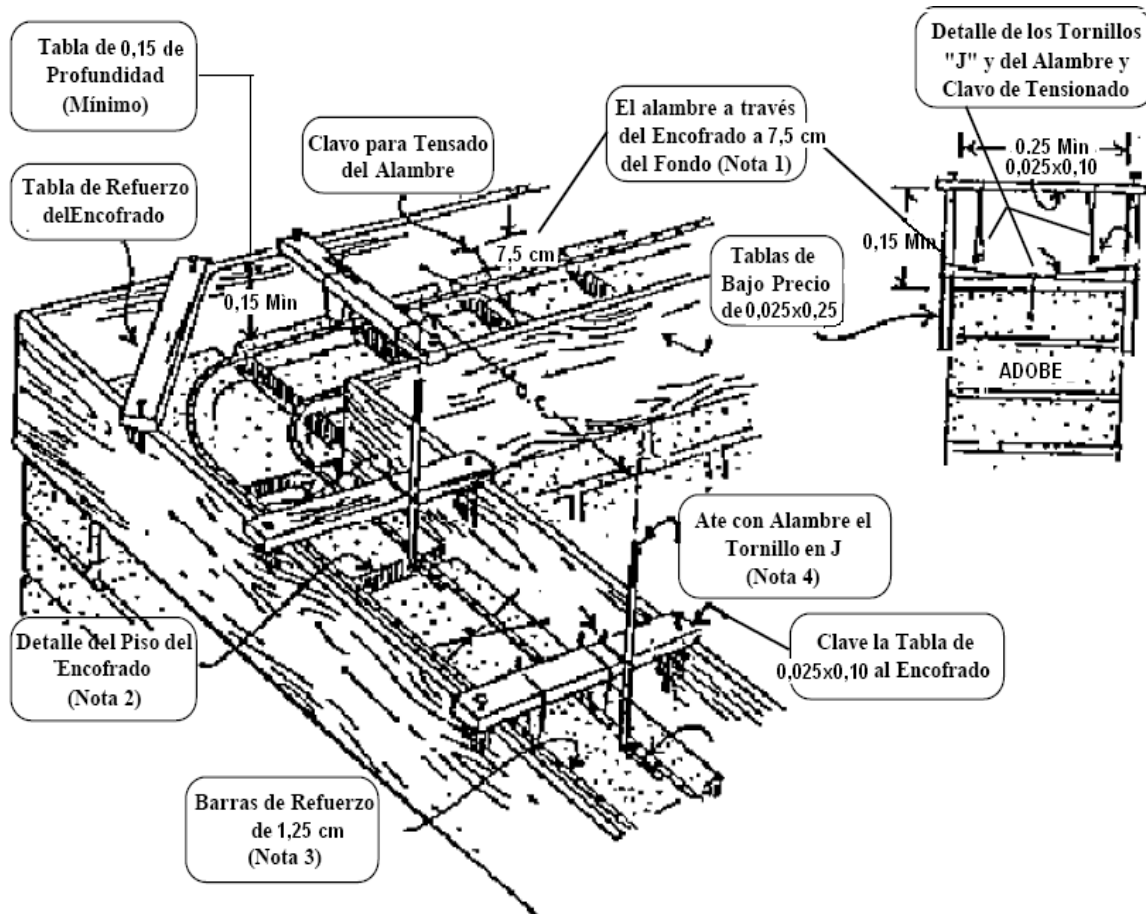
Detalle del Encofrado para la Viga de Unión.
